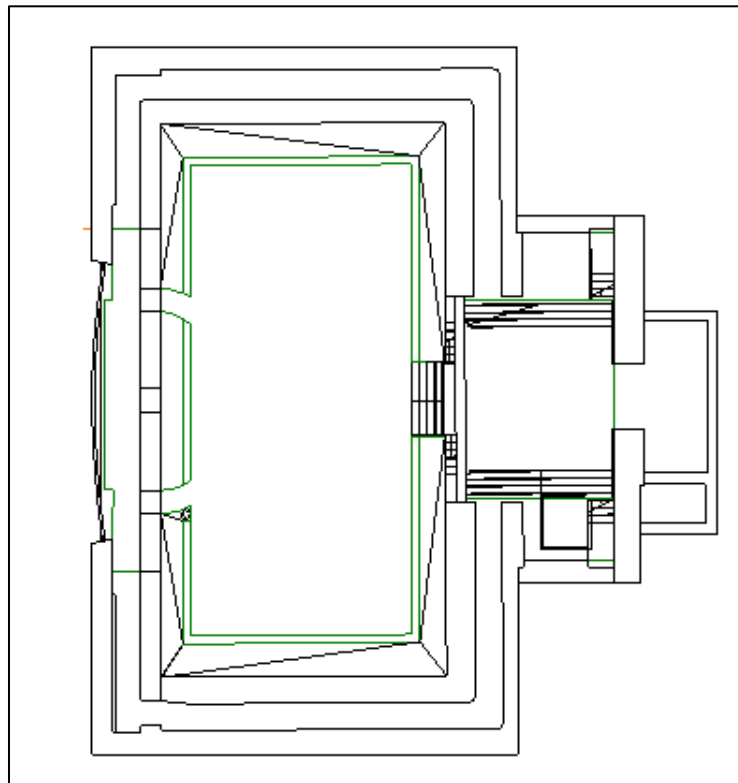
Vista en planta sótano en el nivel TN-S2 de las entidades creadas en el sótano en Revit
